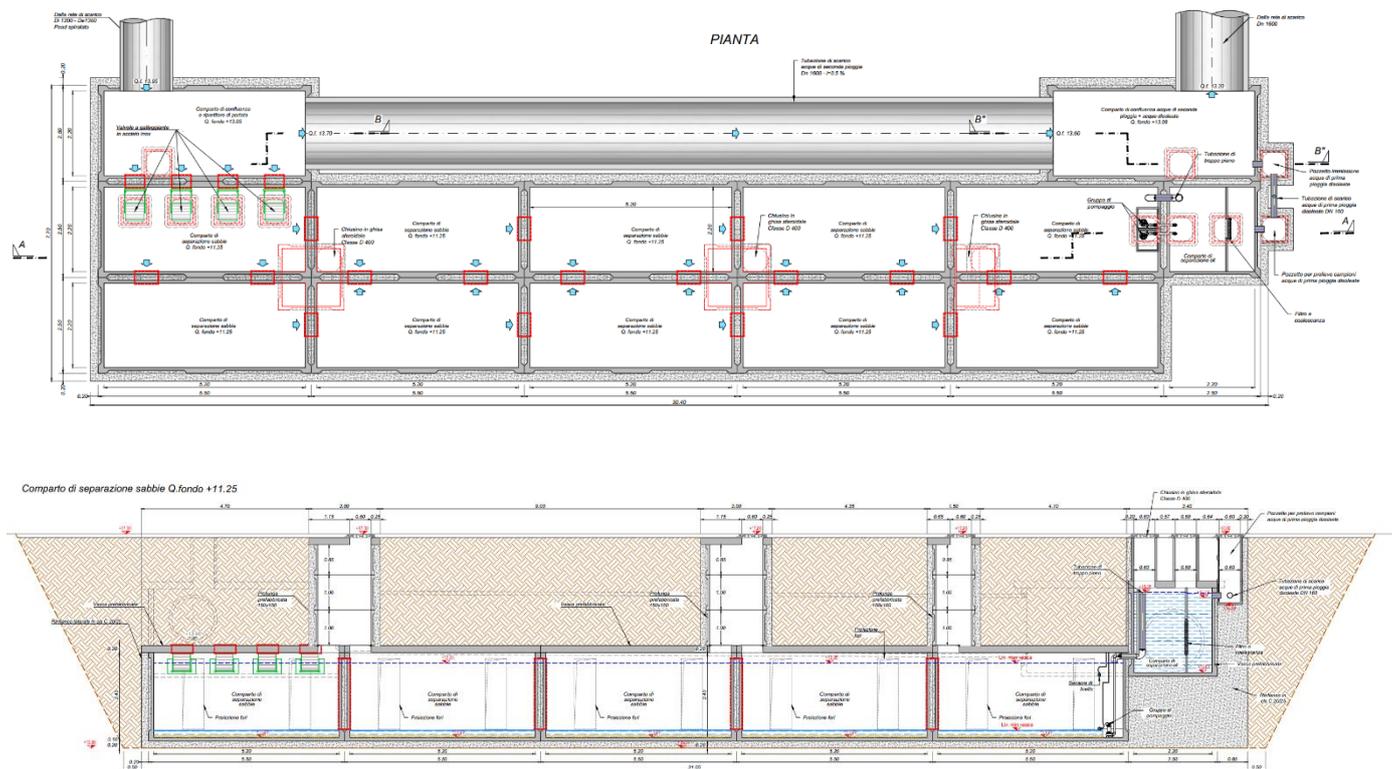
Pianta e sezione longitudinale della Vasca di prima pioggia Executive “Monte”
